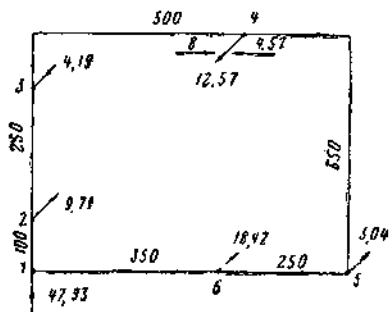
Расчетная схема отбора воды из наружной сети до пожара
